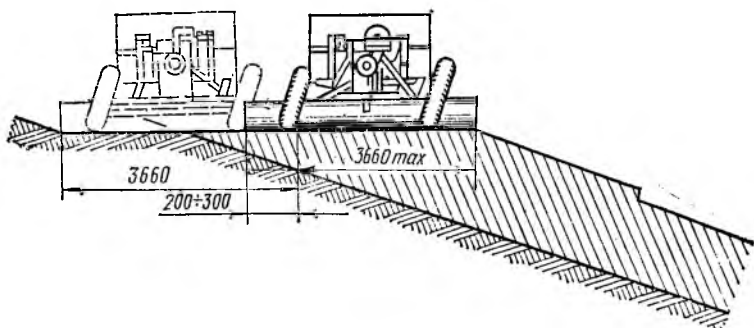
Схема планировки откосов насыпи крутизной 1:3 грейдерами
